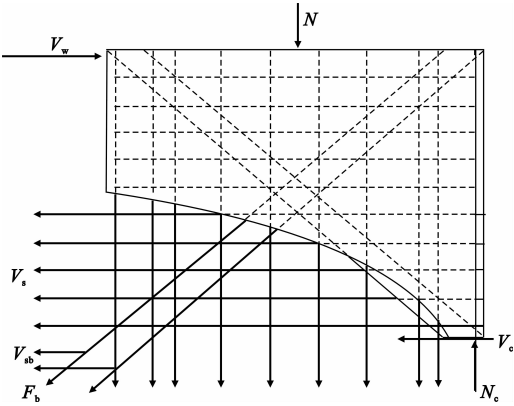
钢筋混凝土墙板抗剪承载力计算模型
